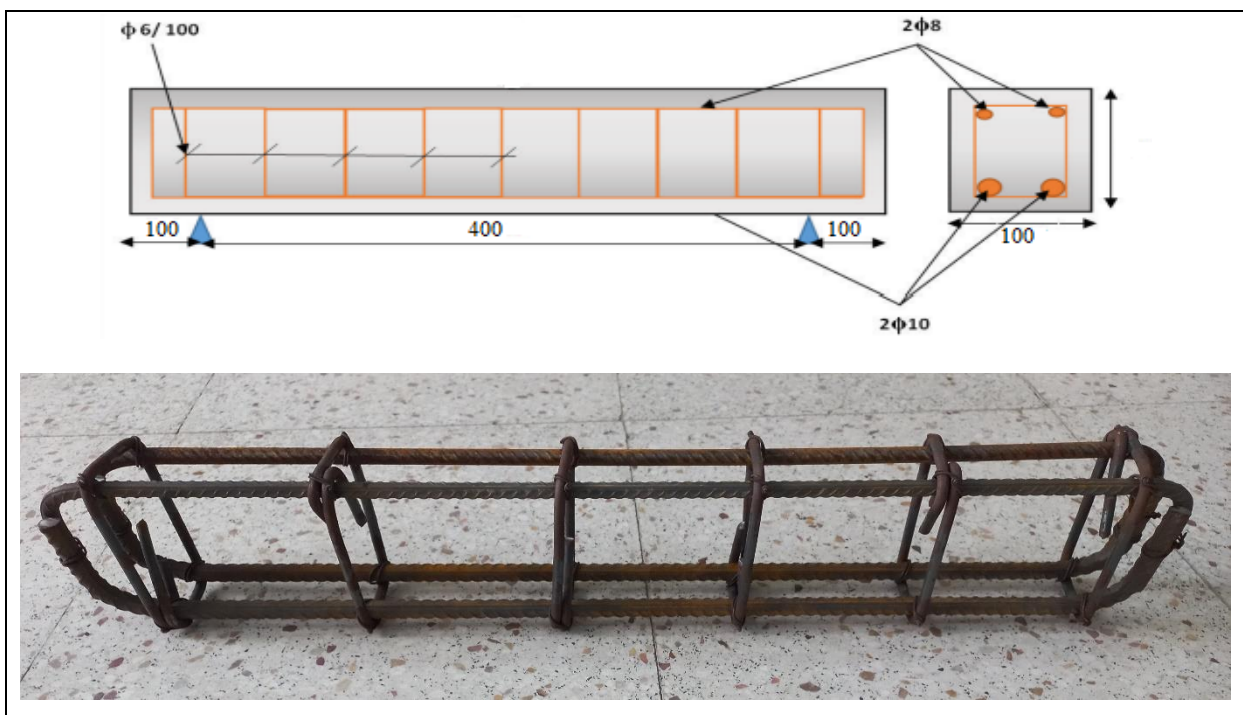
Ferrailage des poutres testées (l'unité en mm)
